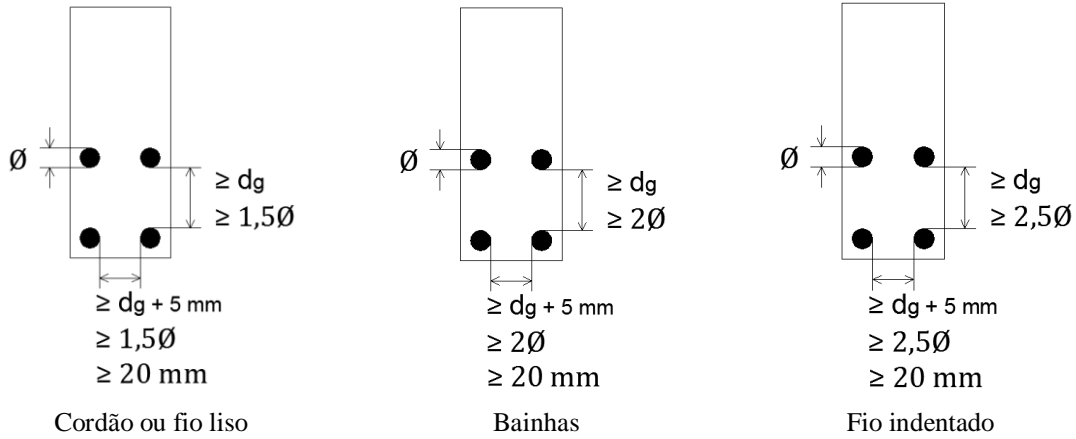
Afastamento das armaduras pré-tensionadas (Marques, J. 2013)
